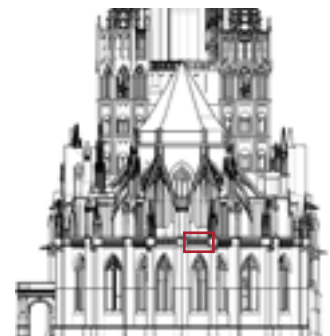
und des rechten Werkstückes, das mit einer Schräge zum
